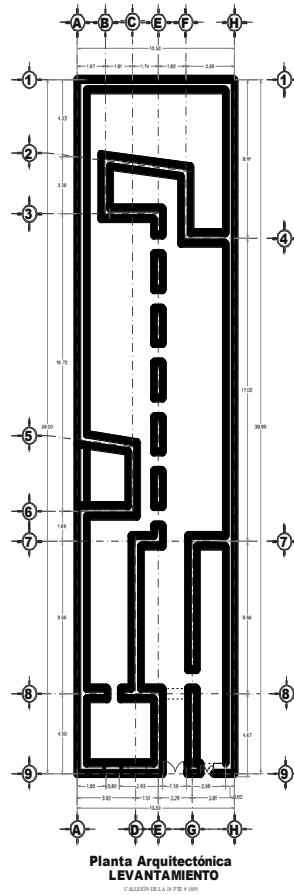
Levantamiento en planta del predio. Elaboración propia
